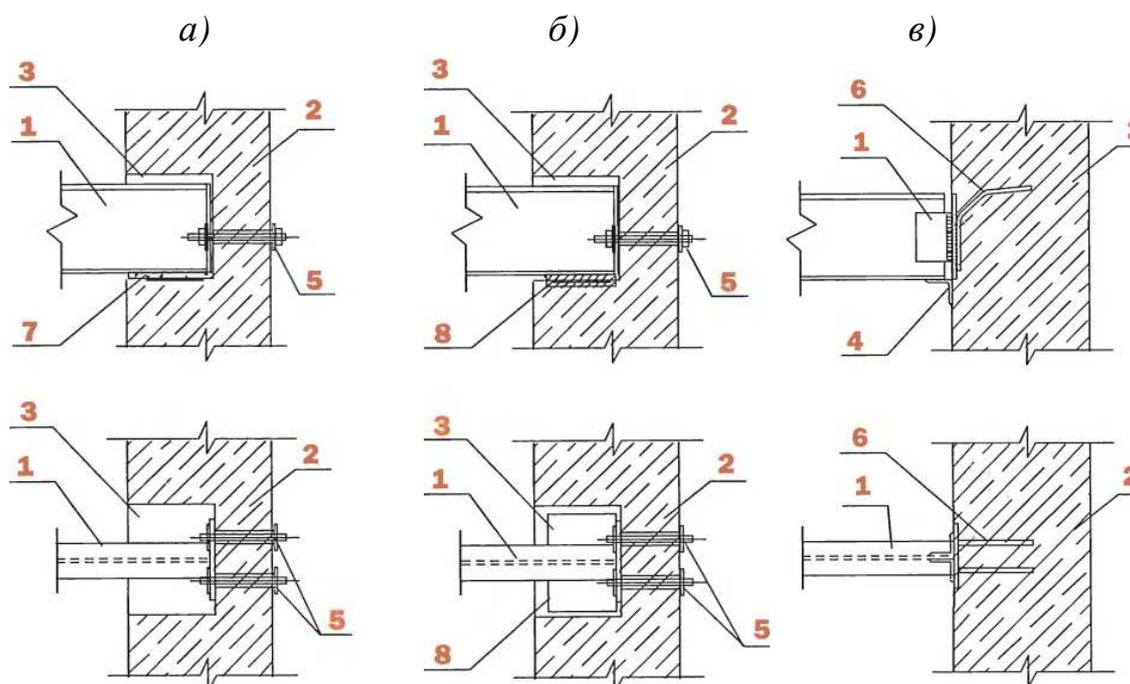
Принципиальные конструктивные решения по узлам опирания стальных балок на железобетонную стену для высотных зданий: *а* – через слой выравнивающего цементно-песчаного раствора; *б* – то же, через опорные металлические прокладки; *в* – через консольные стальные опорные столики; 1 – стальная балка; 2 – железобетонная стена; 3 – опорная ниша в стене; 4 – опорный столик; 5 – затяжной анкер; 6 – закладная деталь в стене; 7 – выравнивающий цементно-песчаный раствор; 8 – стальная прокладка
